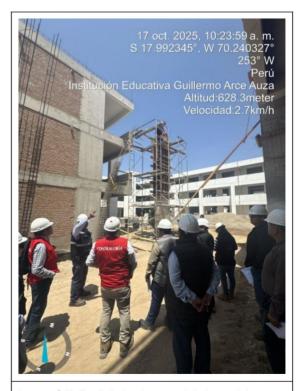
Encofrado de columna en el nivel secundario.
